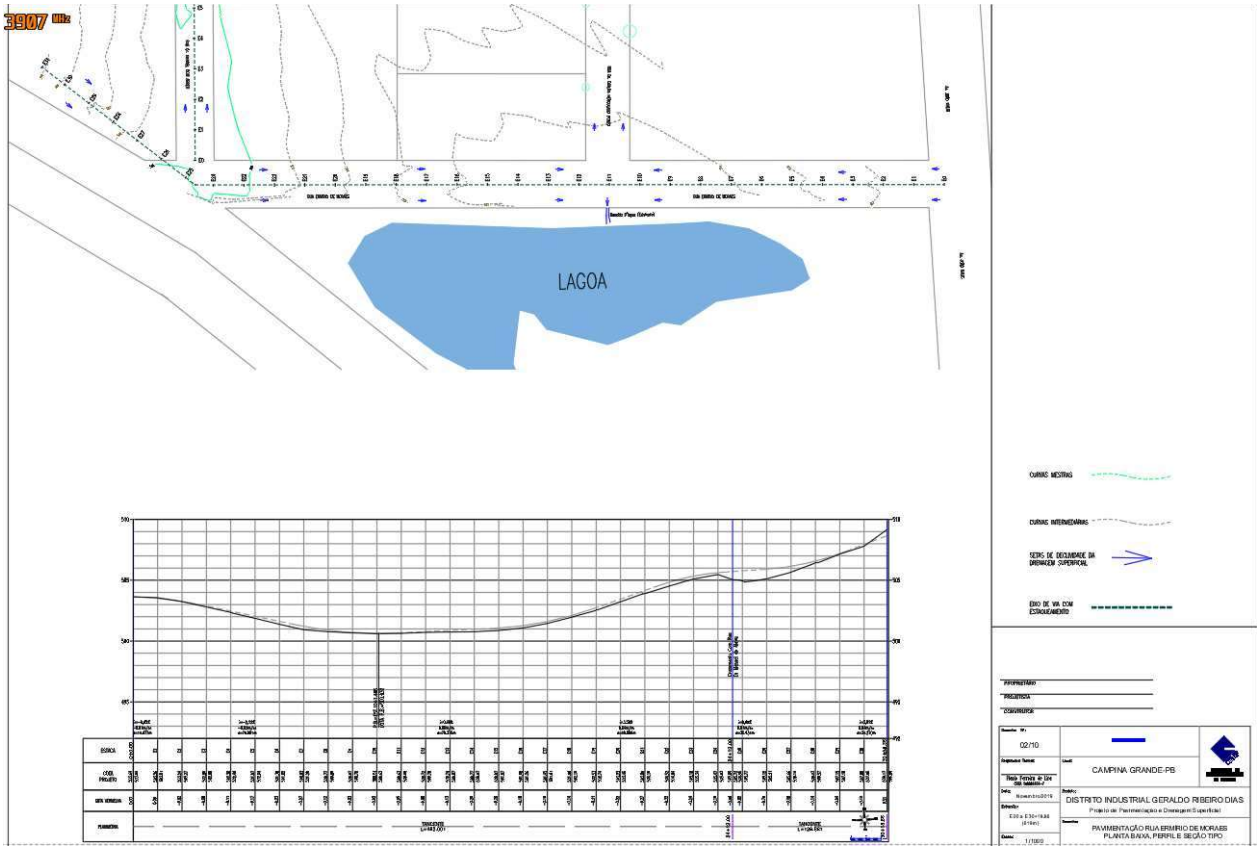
Demonstração de representação de eixo com curvas de nível e perfil longitudinal em planta A3.
